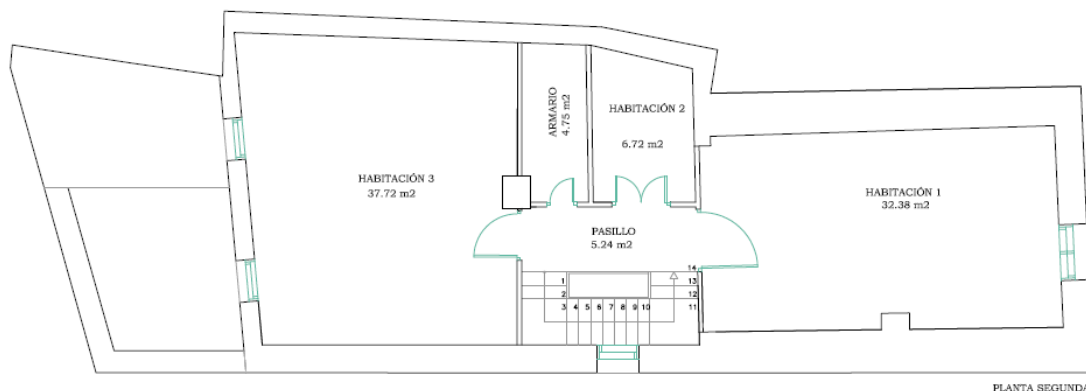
Plano distribución y superficies planta segunda Anexo 9.2 P.8
